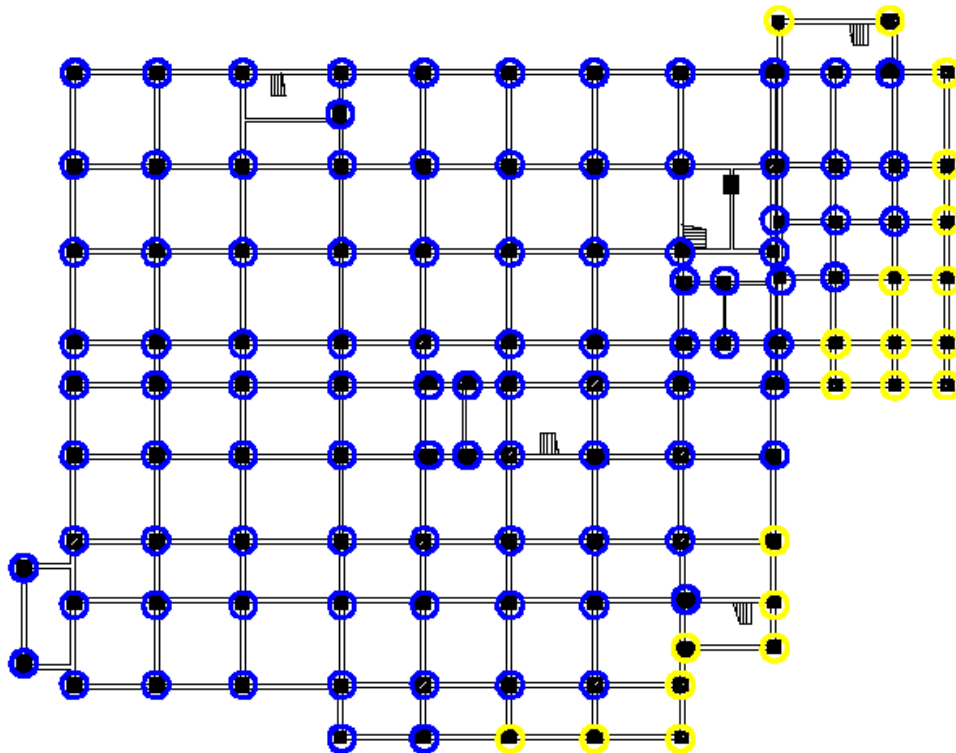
Vista en planta de la distribución de Aisladores (Azul) y deslizadores (Amarillo)
